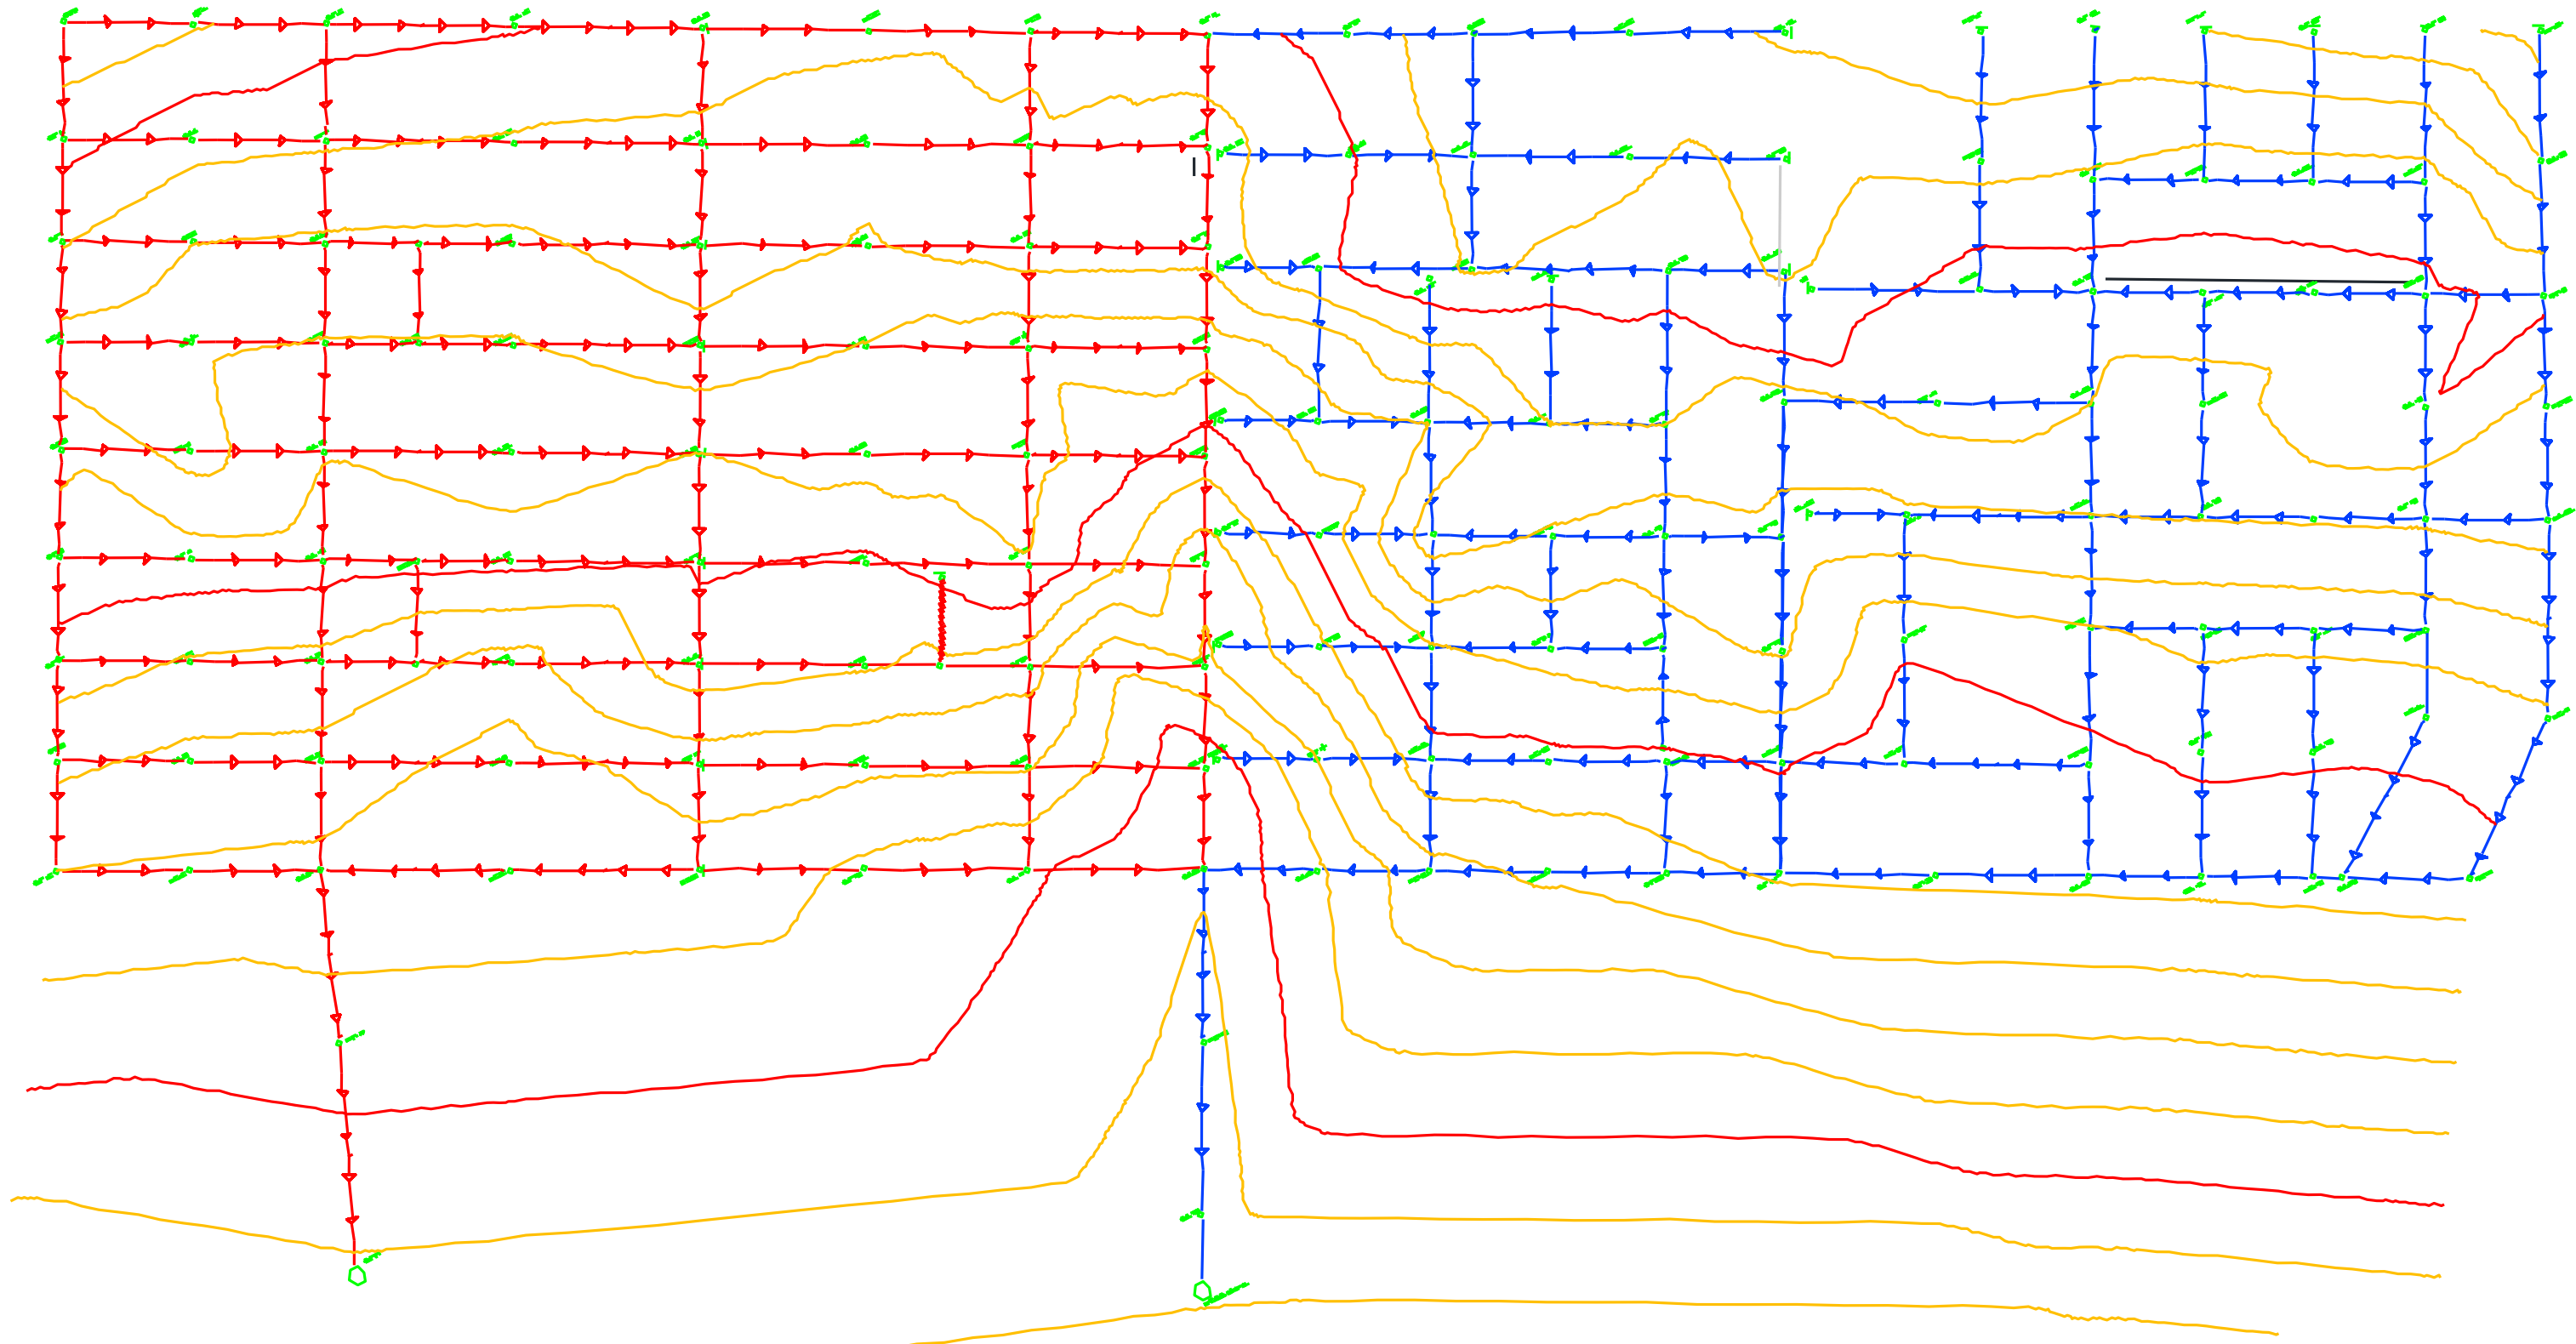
Esquema de la Red de Alcantarillado Barrio 6B – Barrio 7B
